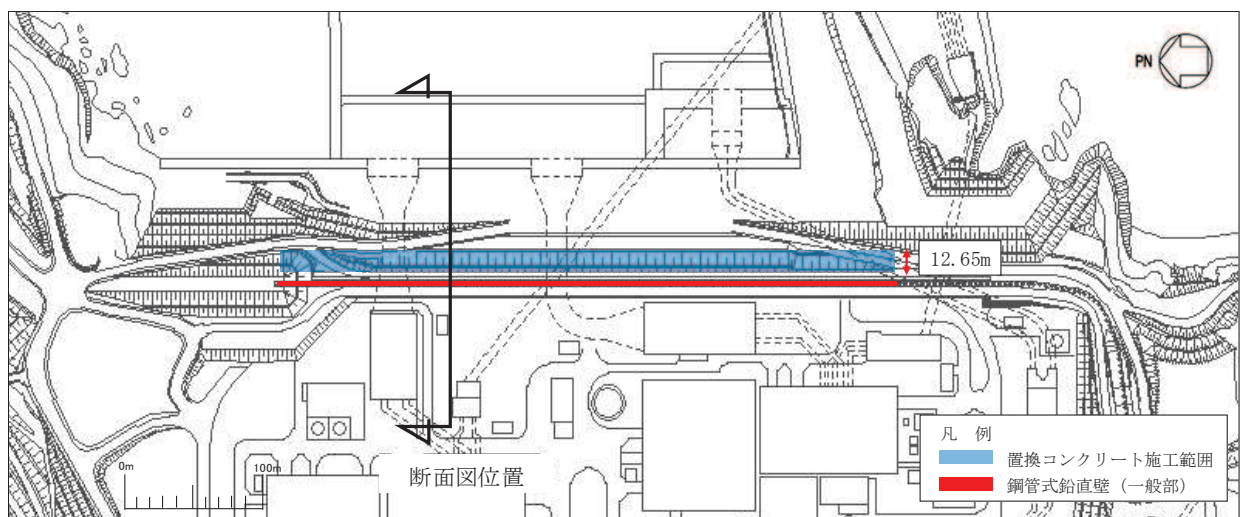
(1) 置換コンクリートの施工範囲（平面図）
